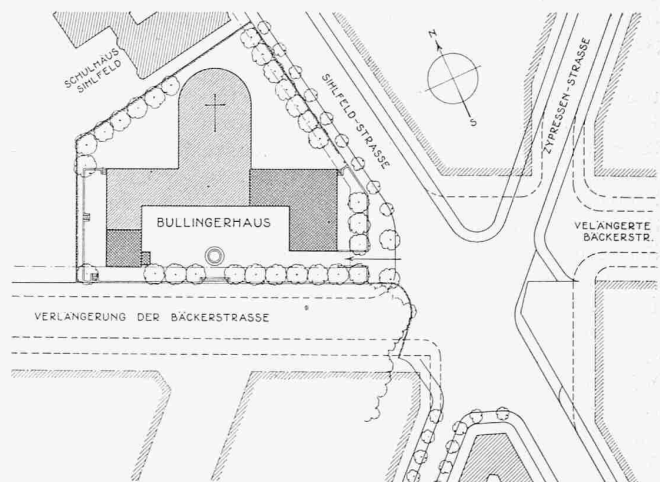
Lageplan des Kirchgemeindehauses Zürich 4. — Masstab 1 : 2000.
